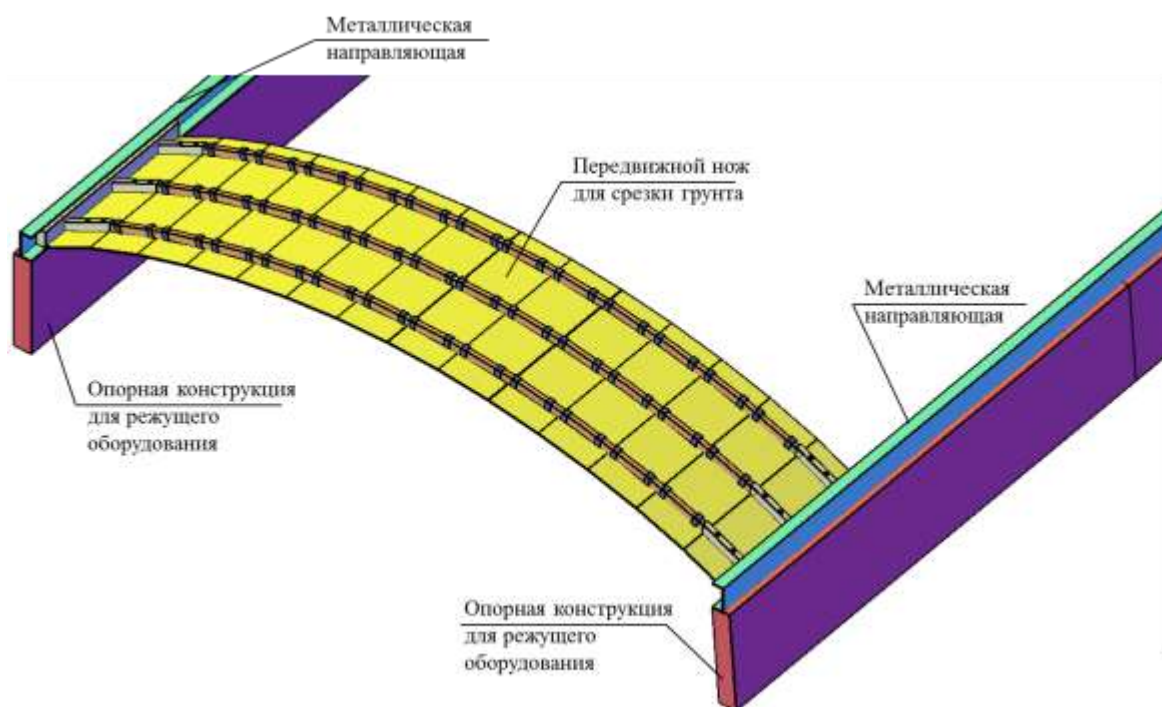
Общий вид оборудования «передвижной нож для срезки грунта»
